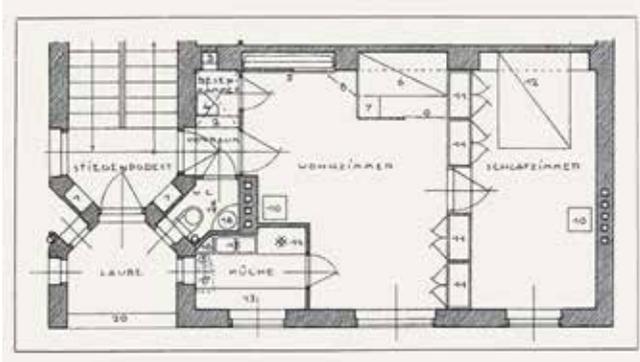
Anton Brenner, Volkswohnhaus Rauchfangkehrergasse, Grundriss, 1924.
